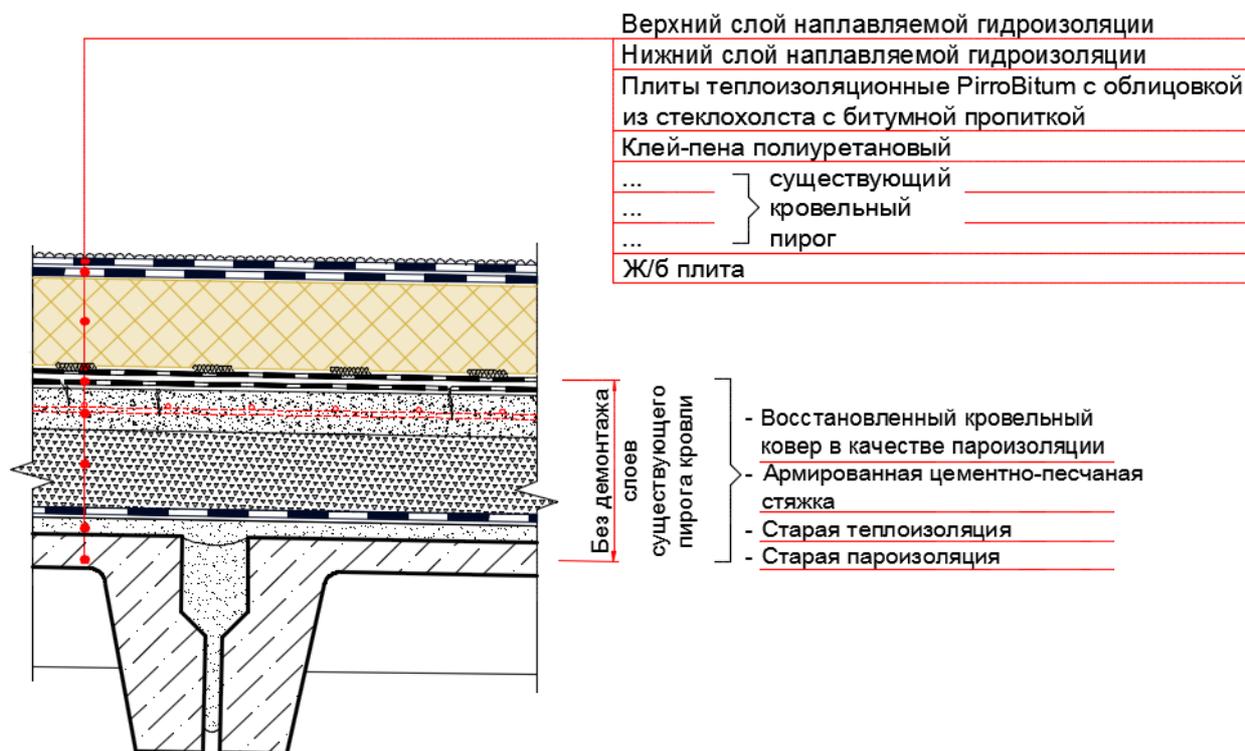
Система крыши PIR-Кровля Битум+ для реконструкции. Работа в 1 этап без демонтажа
